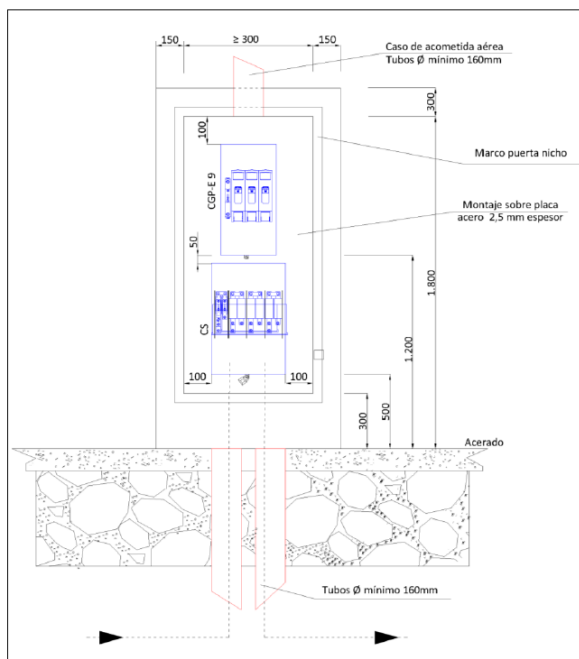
Instalación CGP y CS montaje vertical. Alzado.
